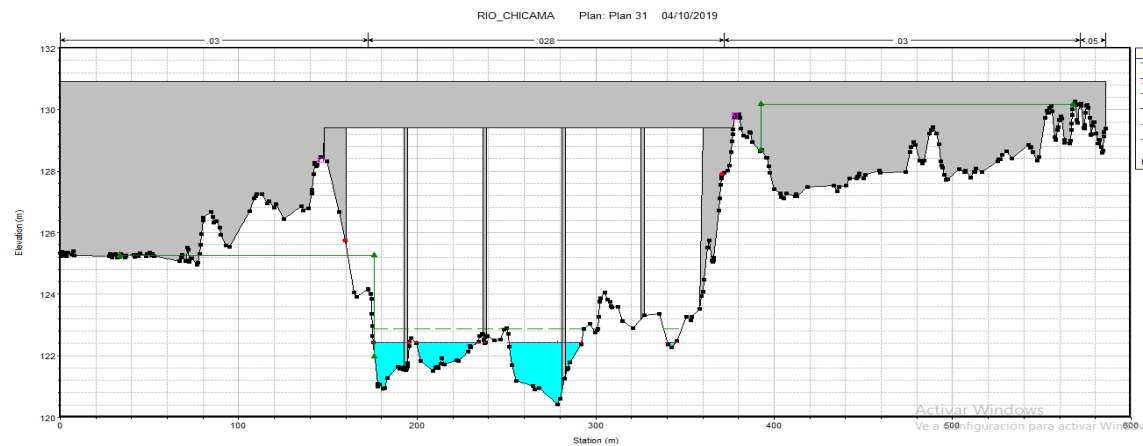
Sección puente Careaga en PF2 con un tirante de 2.73 m.
